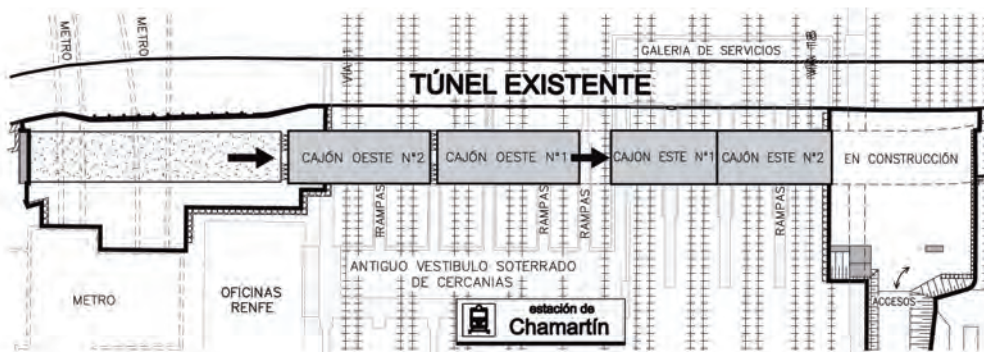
Cajones empujados. Planta Empuje Oeste / West jacking.
